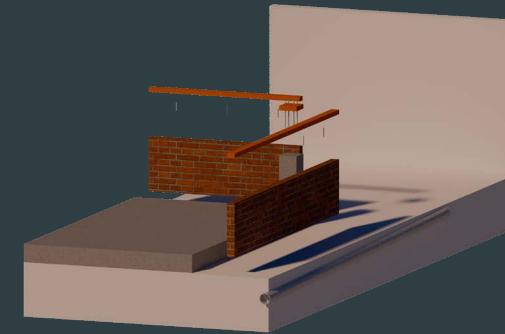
[Estrategia constructiva] Armado y montaje de estructura y cubierta. Fuente: Autor.
